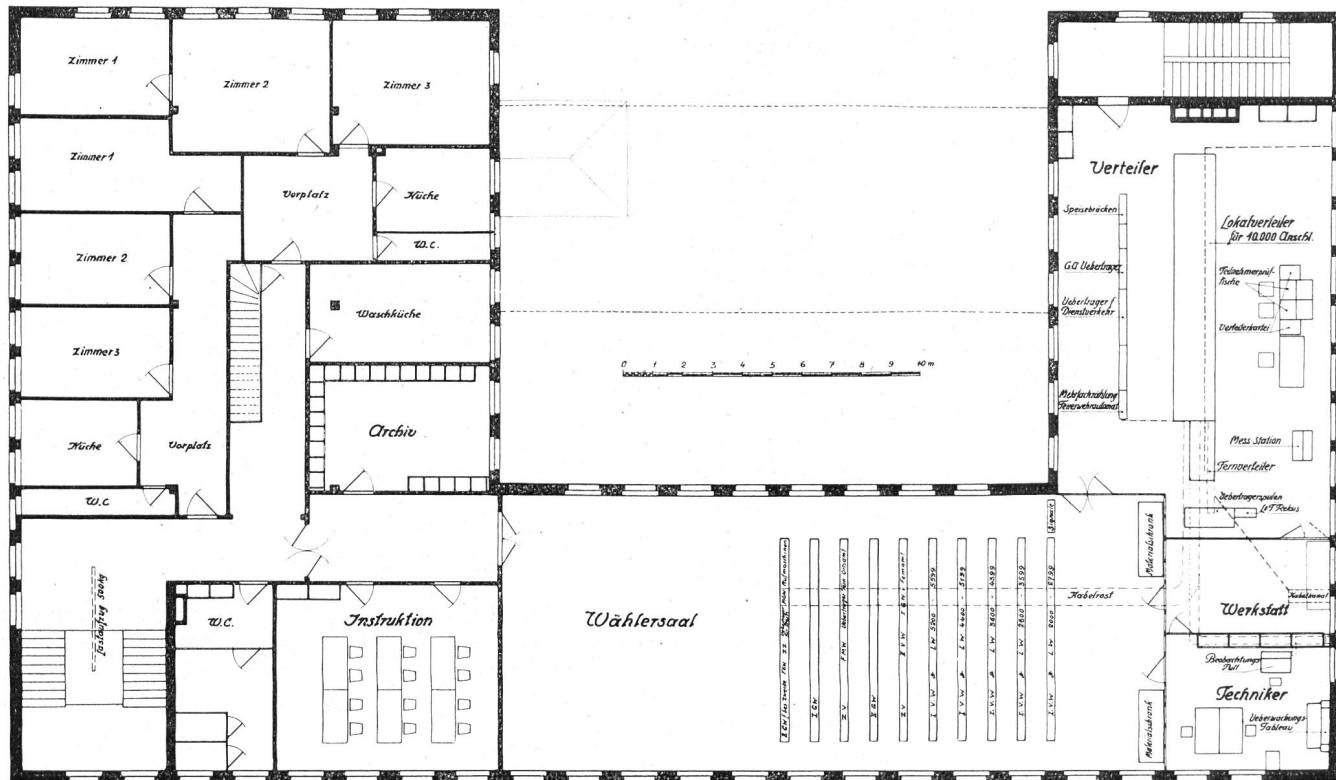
Grundriss des dritten Stockwerkes. — Plan du troisième étage.
